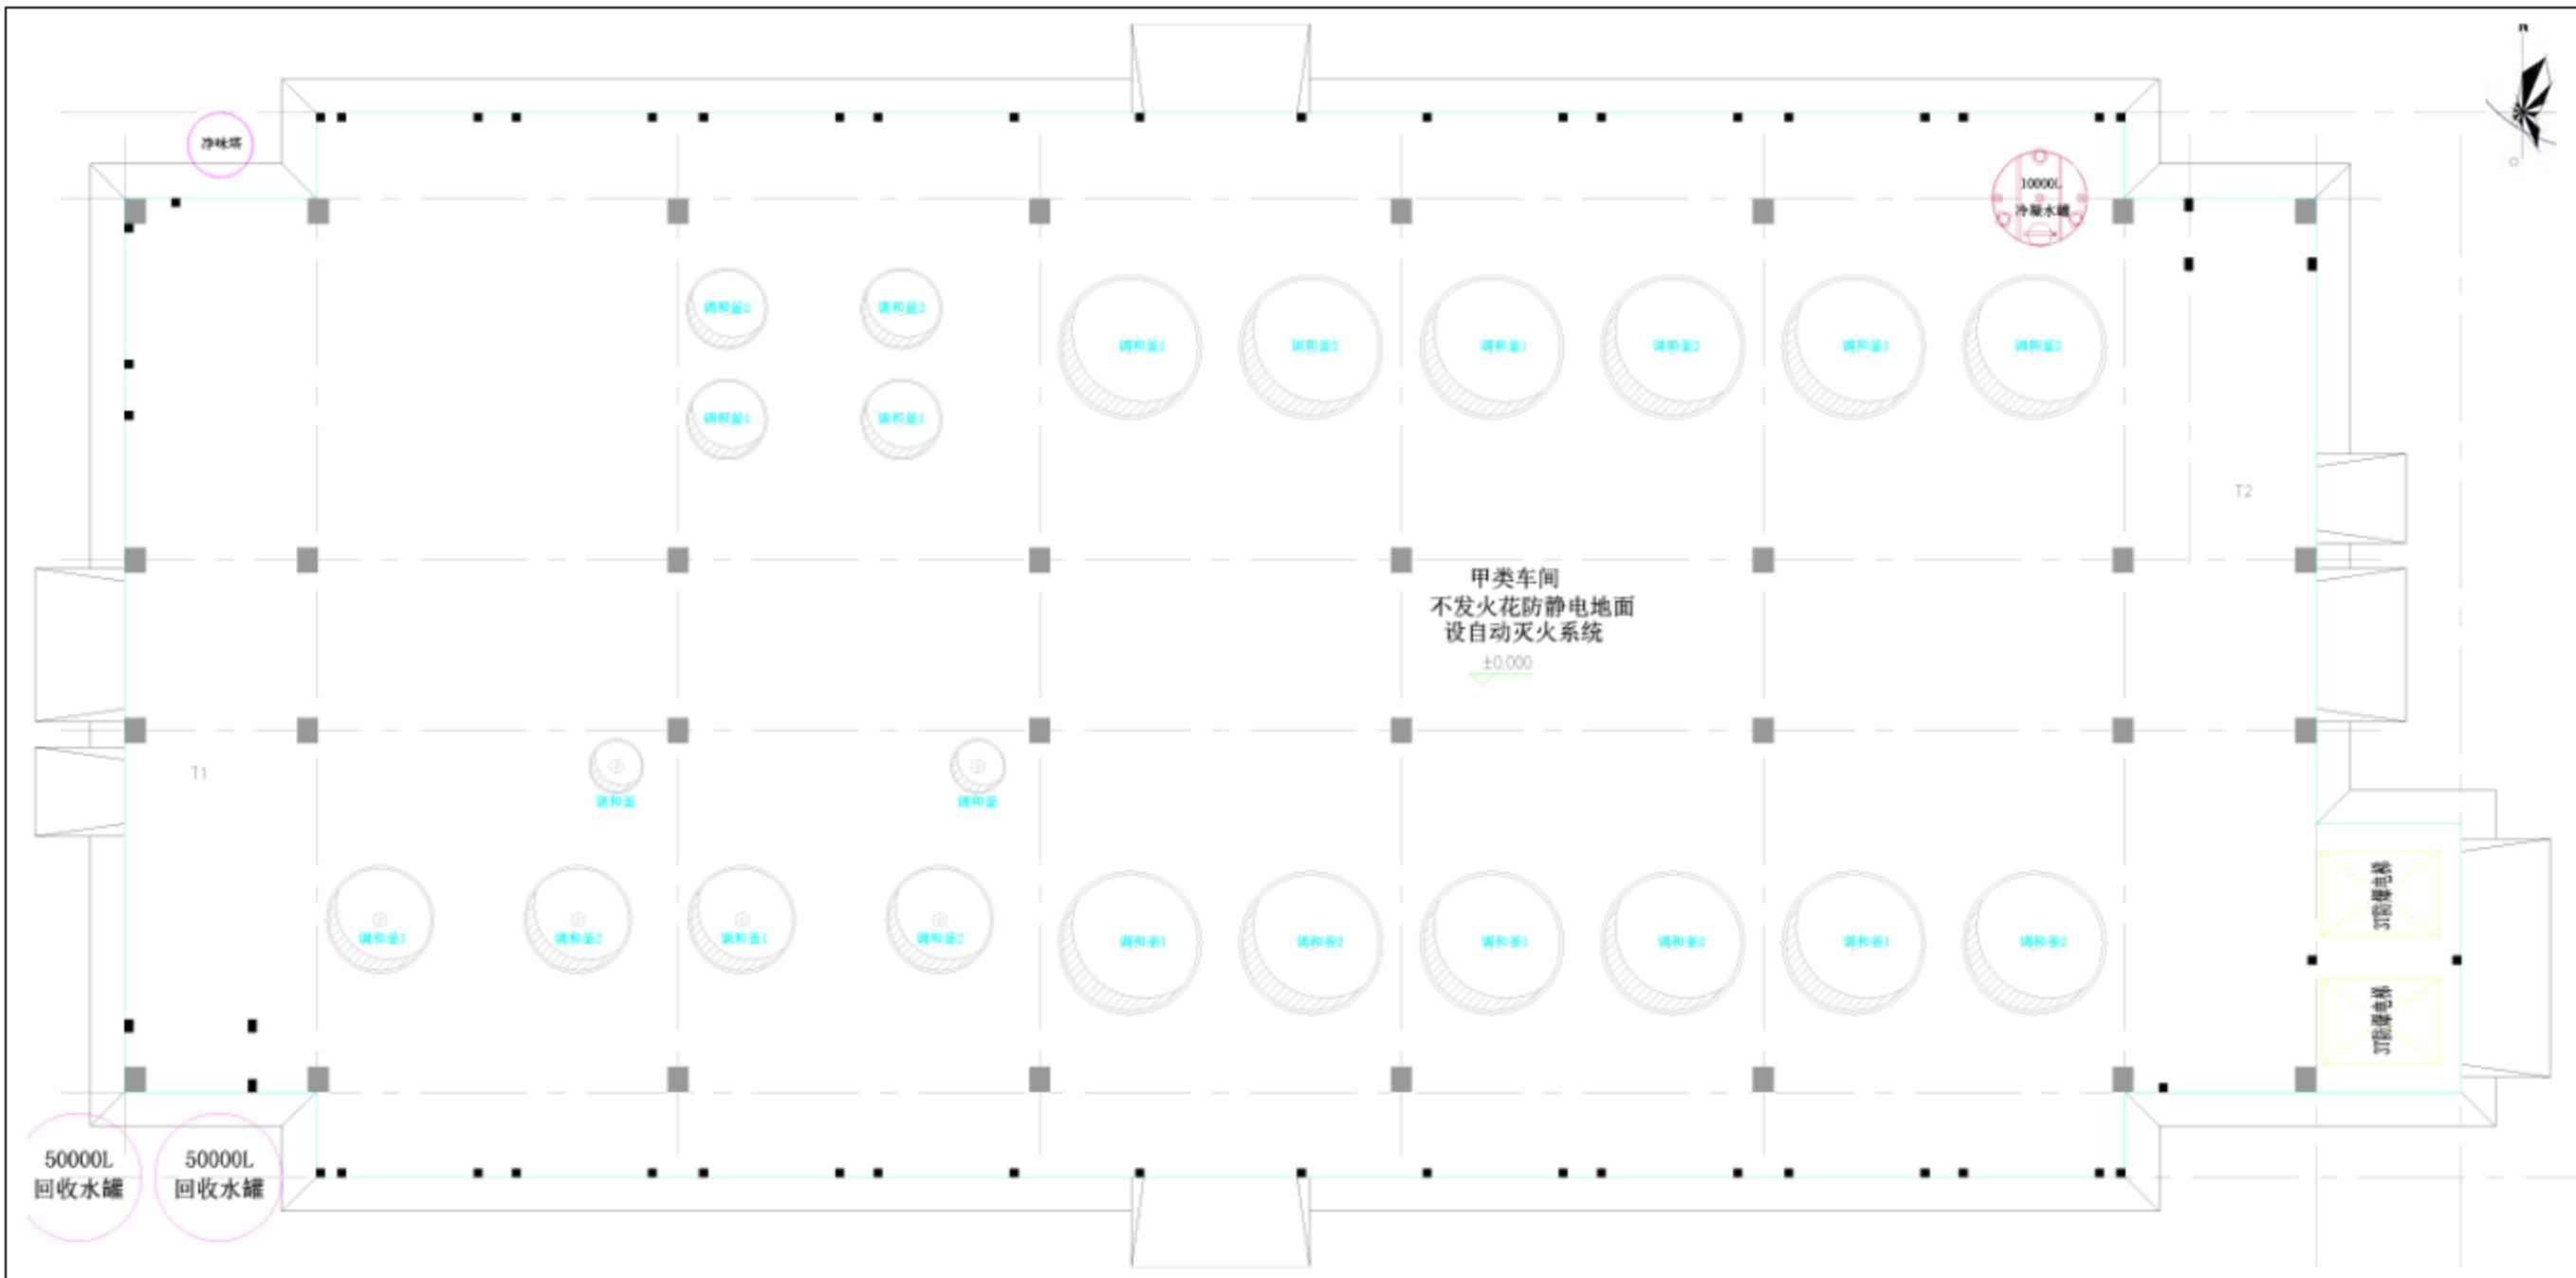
甲类车间B1层平面布置图(比例尺1:100)
